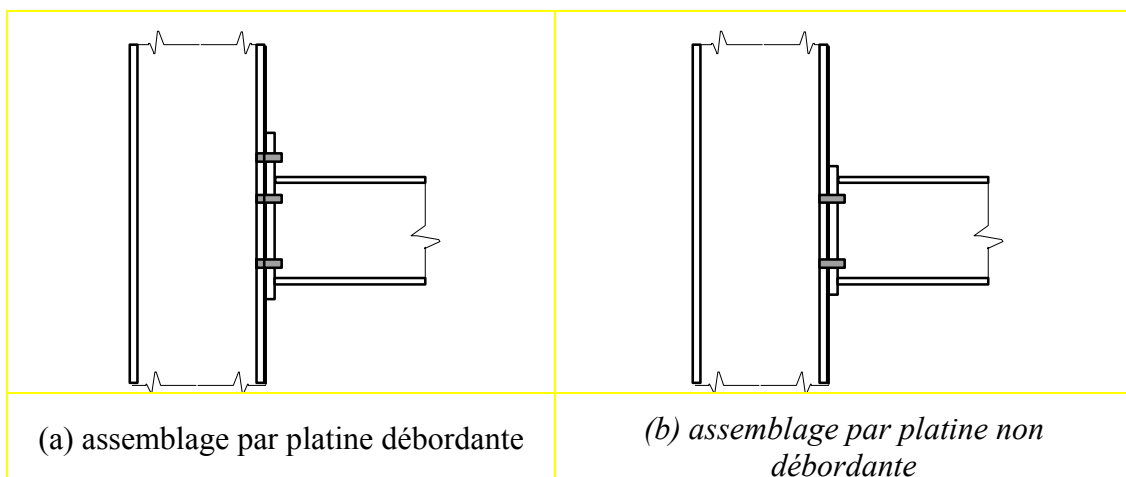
Assemblage poteau poutre par platine d'about boulonnée
